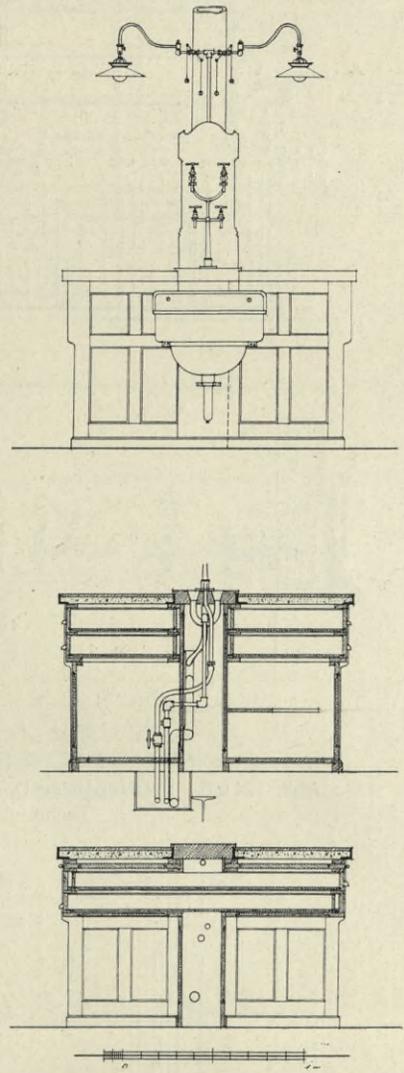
a. Seitenansicht und Schnitte zu Abb. 123.
